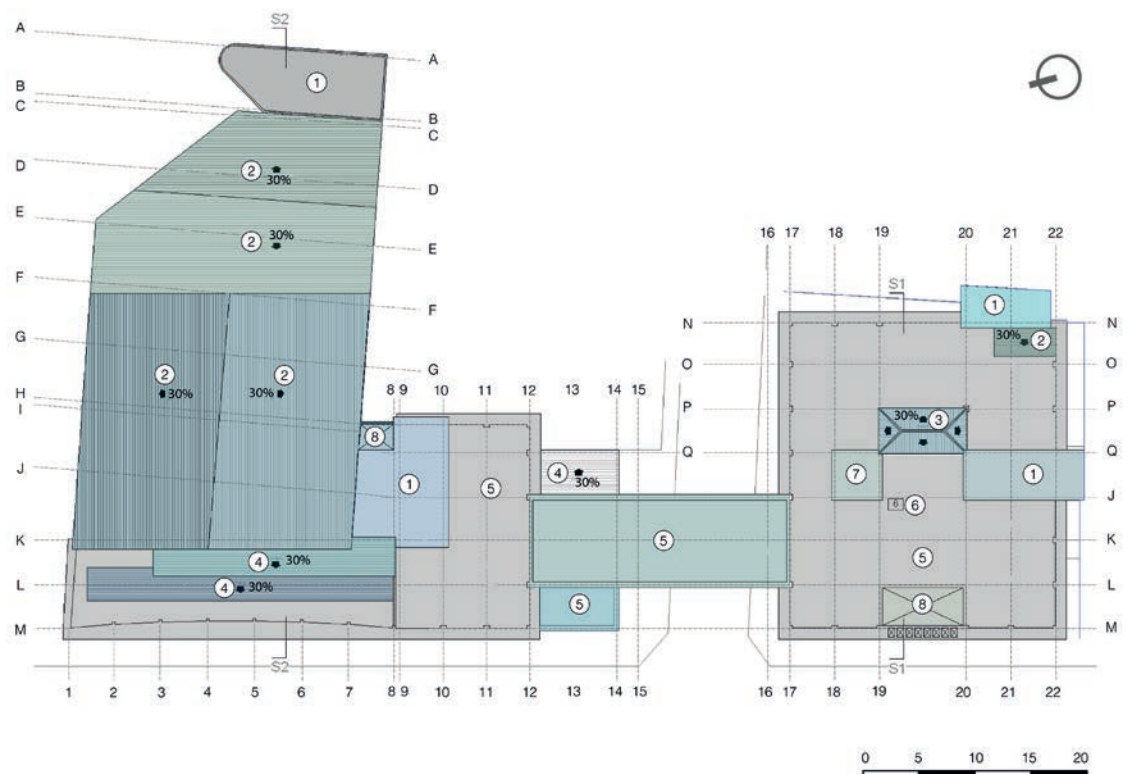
Planta Nivel 4 de la Casa de la Cultura
